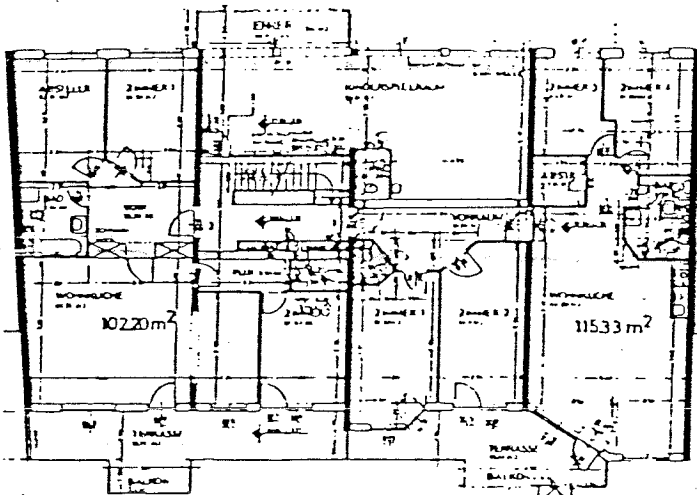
Obergeschoß des Gebäudeteiles Jeneweingasse.
